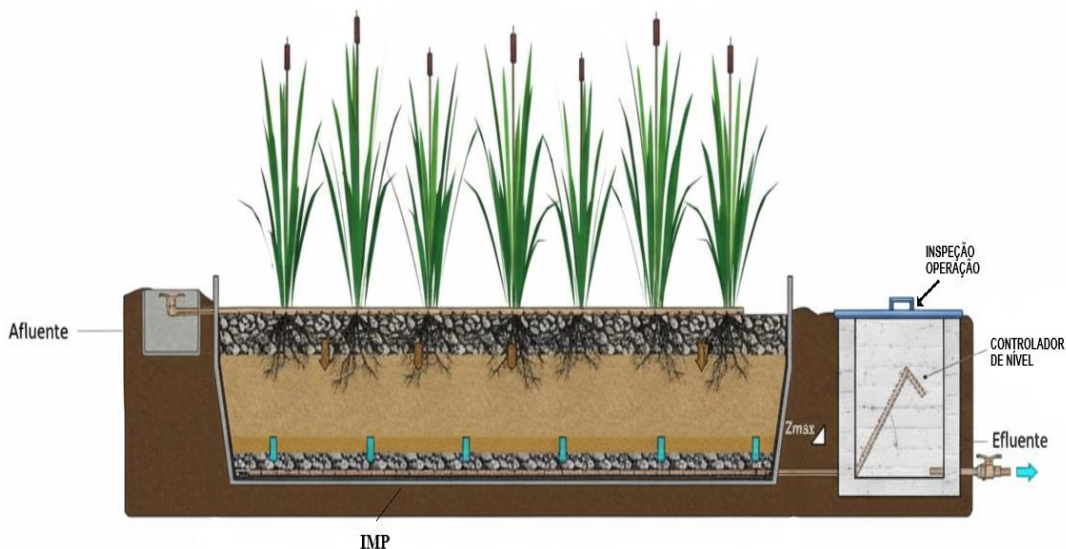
Perfil longitudinal esquemático do *wetland* construído de fluxo vertical.
